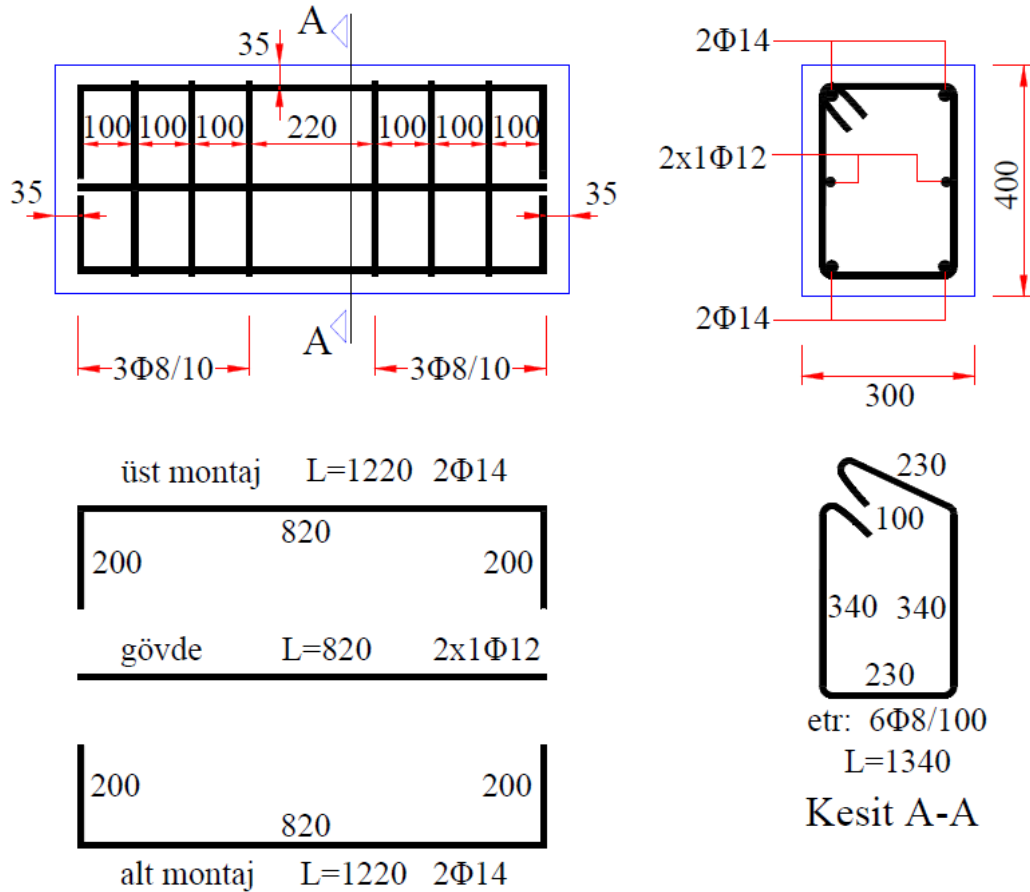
Betonarme boyuna ve sargı donatılarının tasarım planındaki yerleşimi.
